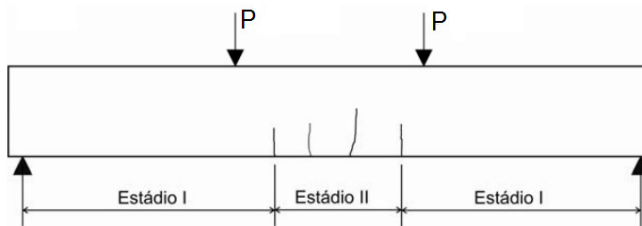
Início do estágio de fissuração (fissuras verticais de flexão pura)
